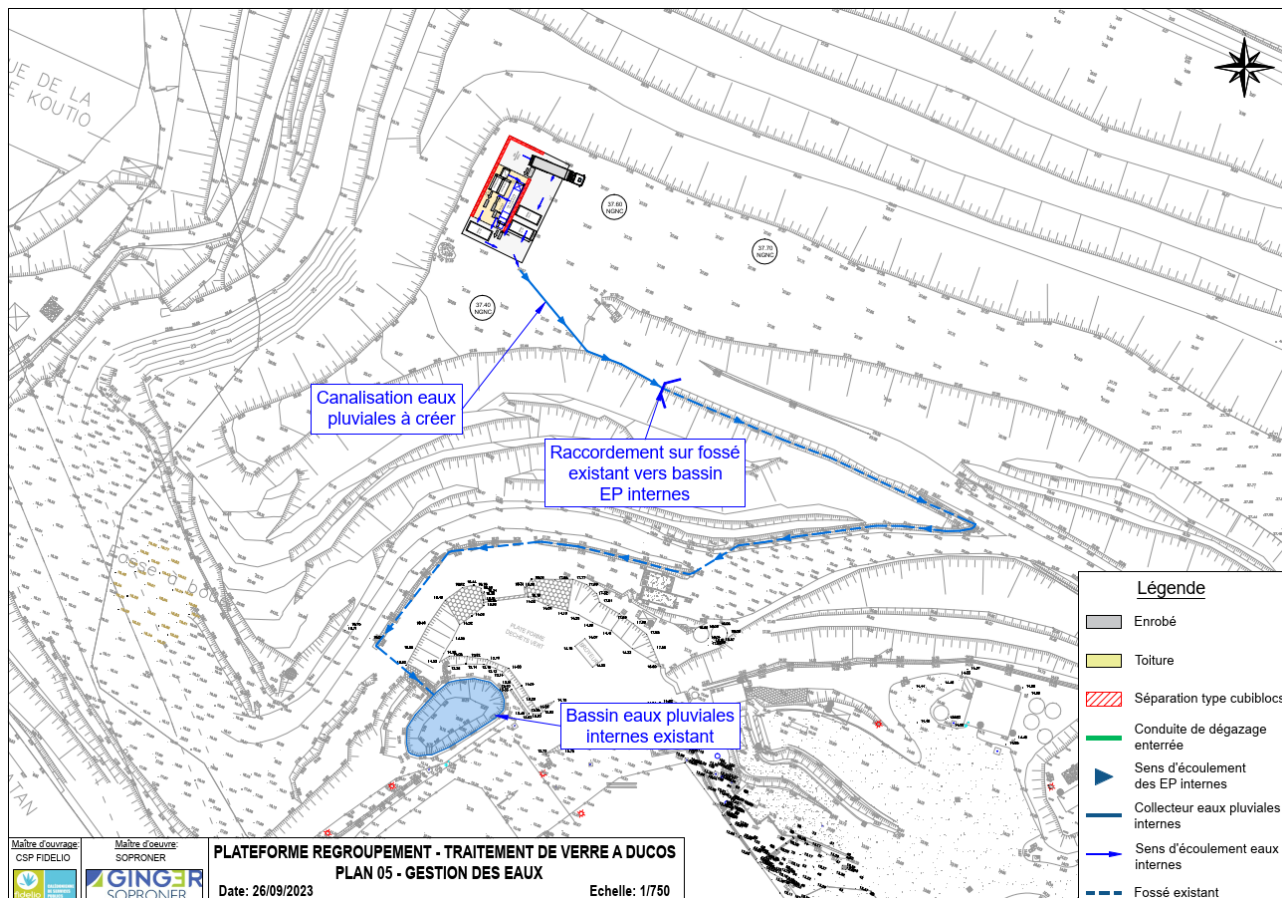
Plan élargi de la gestion des eaux (Annexe 2)
